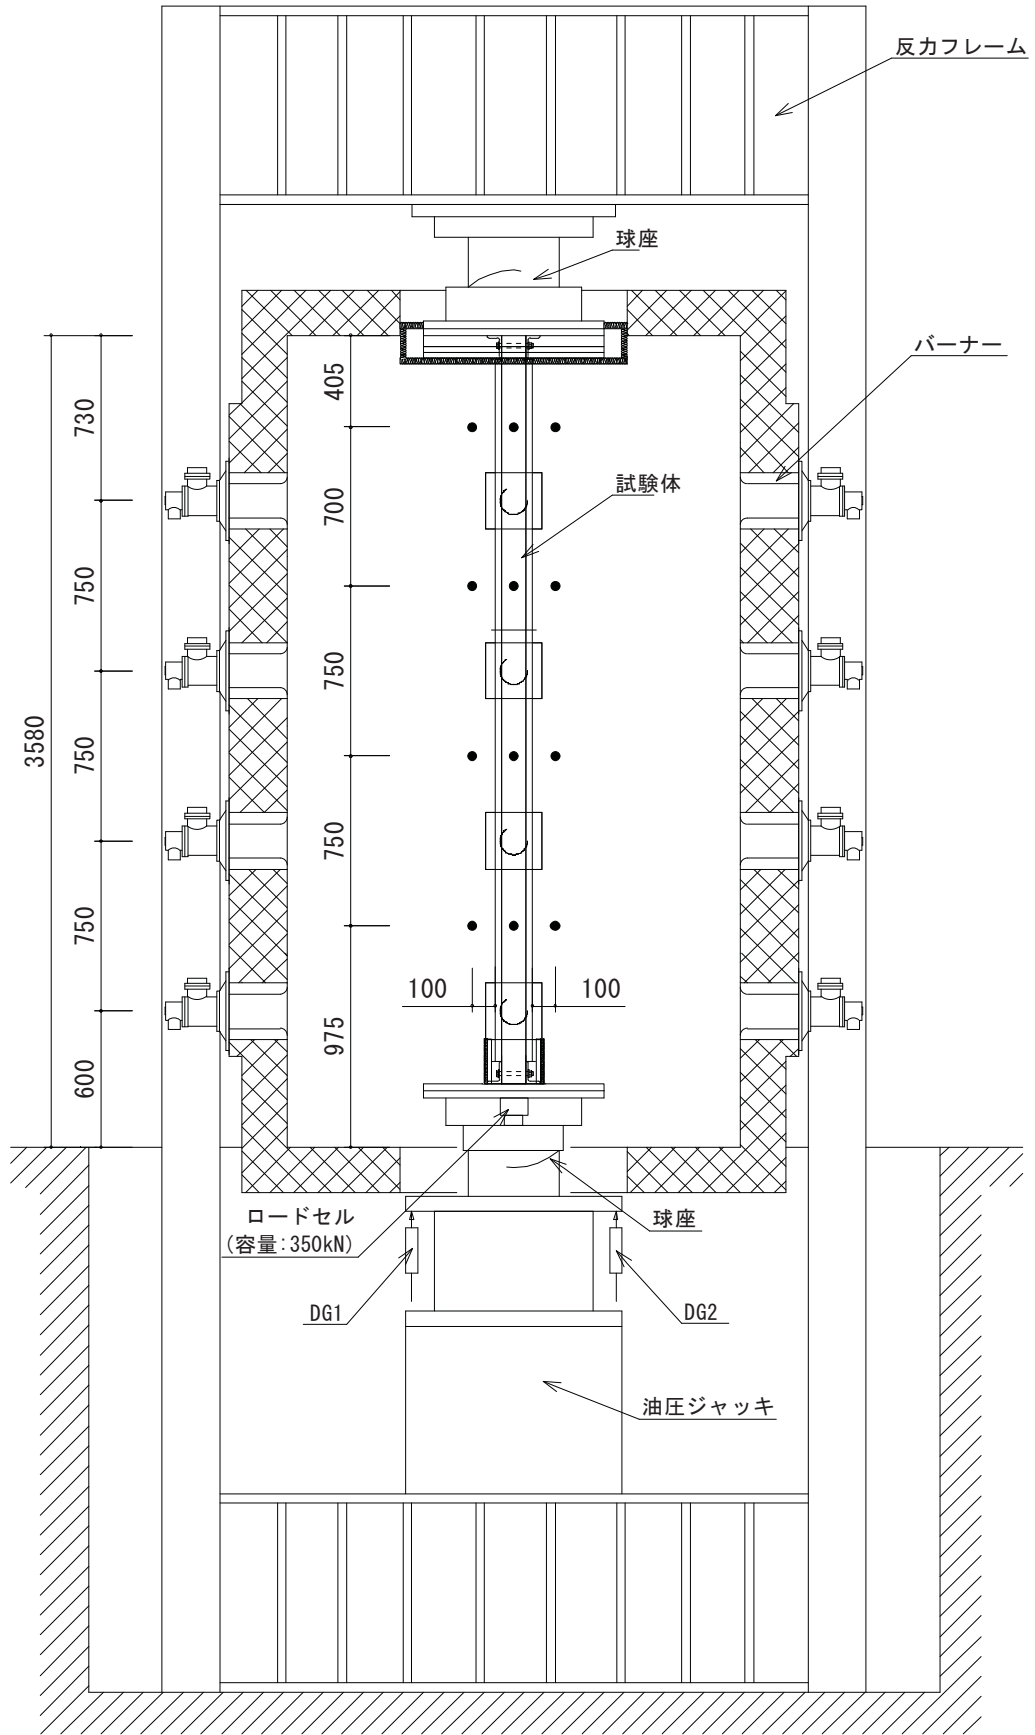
炉内配置図 (鉛直断面) (C-1)
